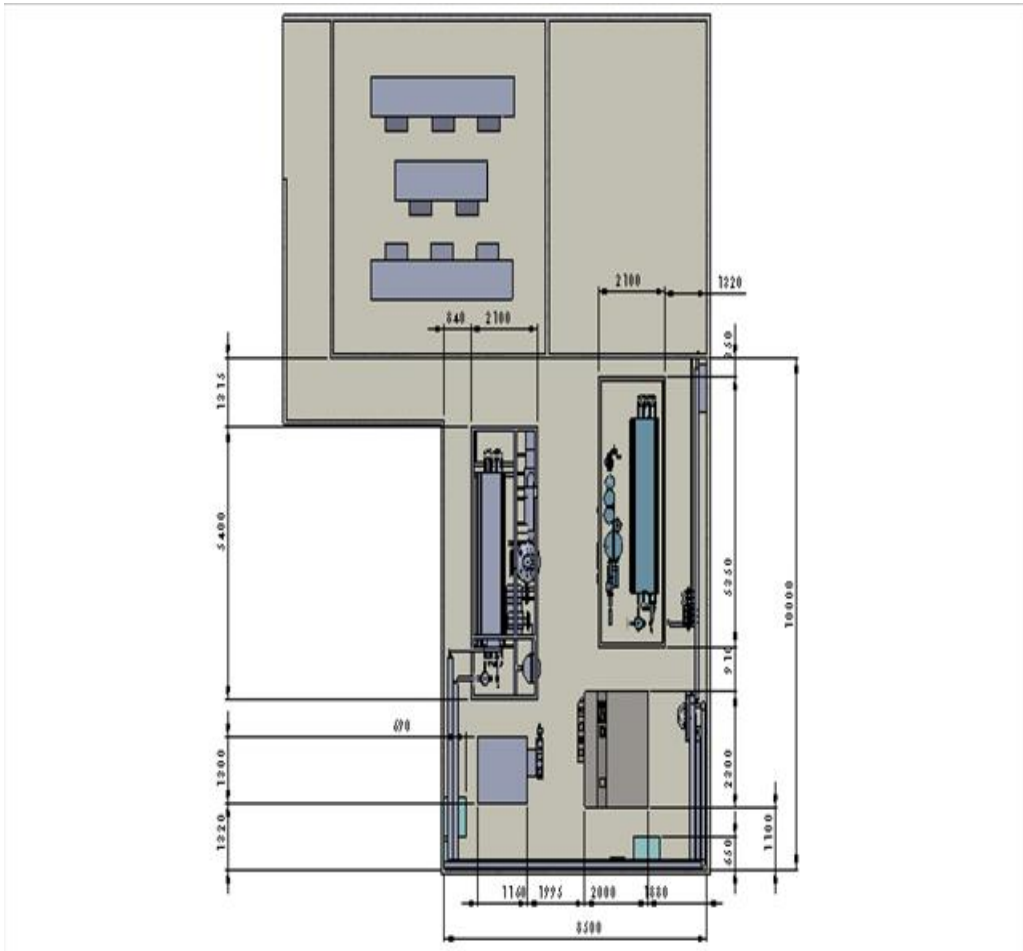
Diseño de Actual de La Planta Sin el Proyecto
